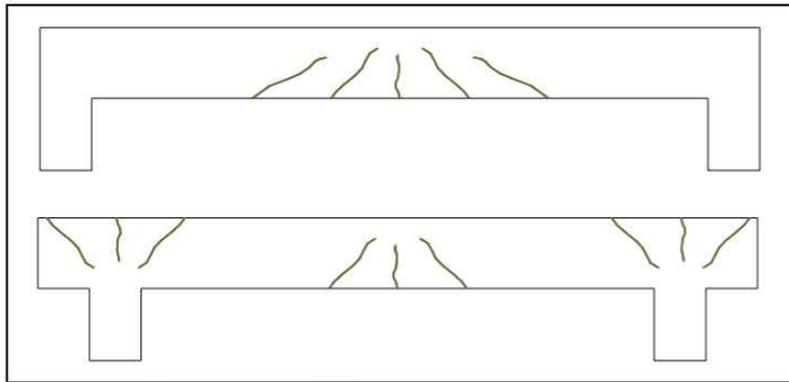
Grietas estructurales en vigas (Do Lago 1997)
